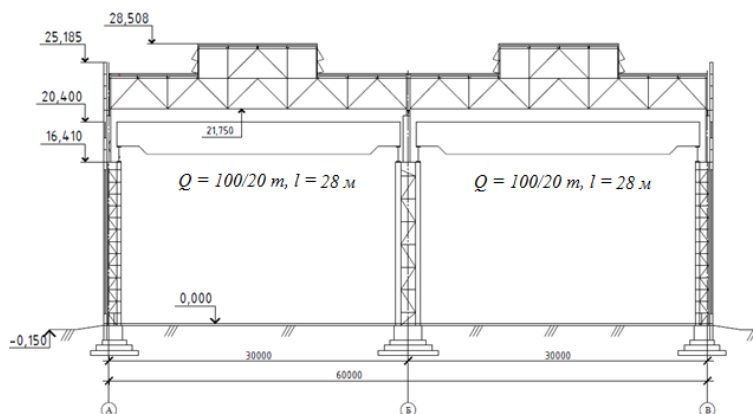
Поперечный разрез одноэтажного промышленного здания
